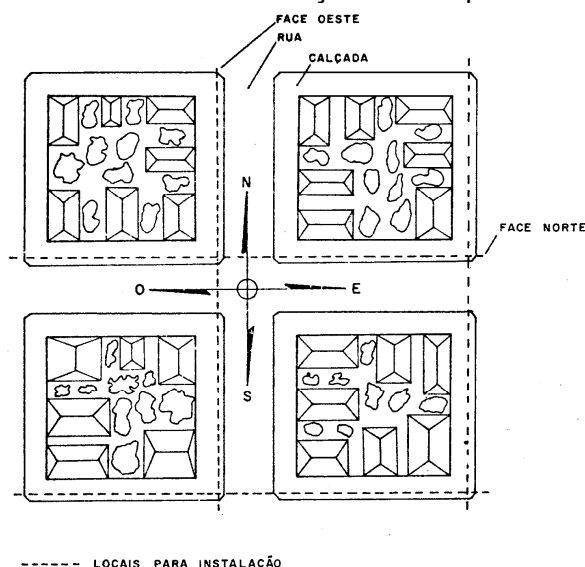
Locais adequados para instalação de rede de distribuição aérea
